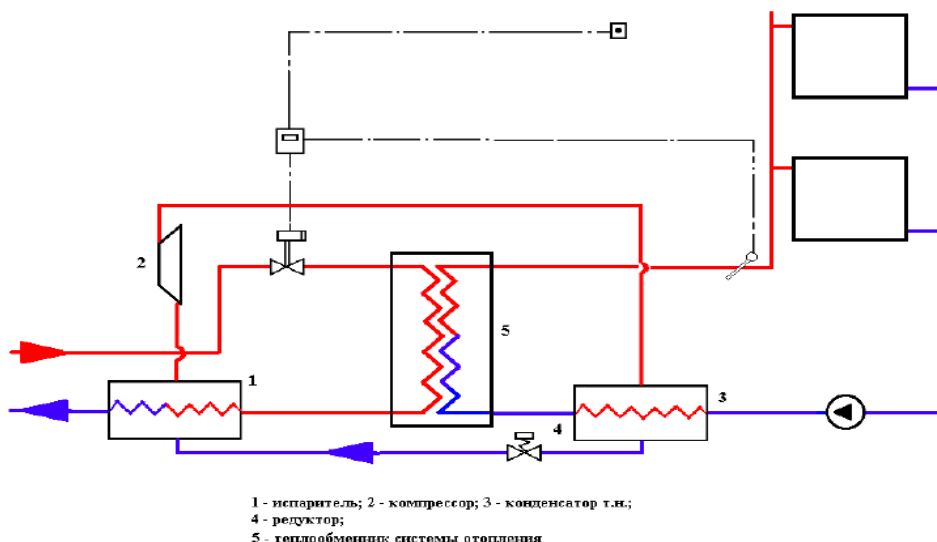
Схема теплового пункта с тепловым насосом на обратном трубопроводе системы отопления
